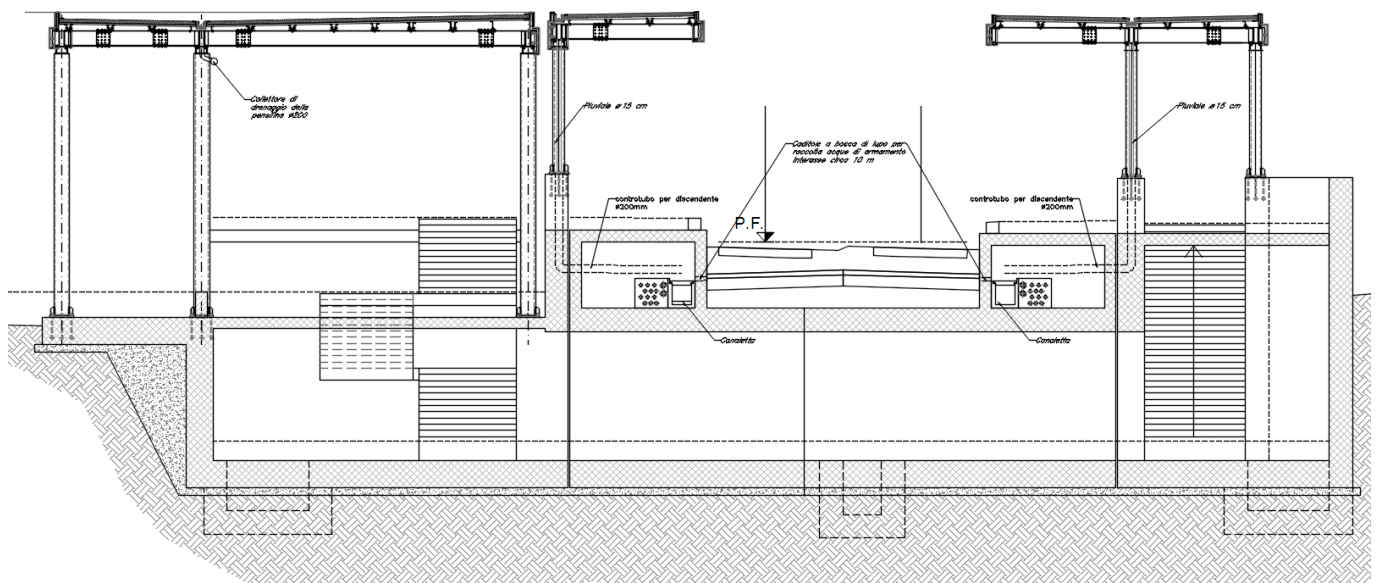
Sezione di carpenetria- Fermata ferroviaria Madonna delle Piane
